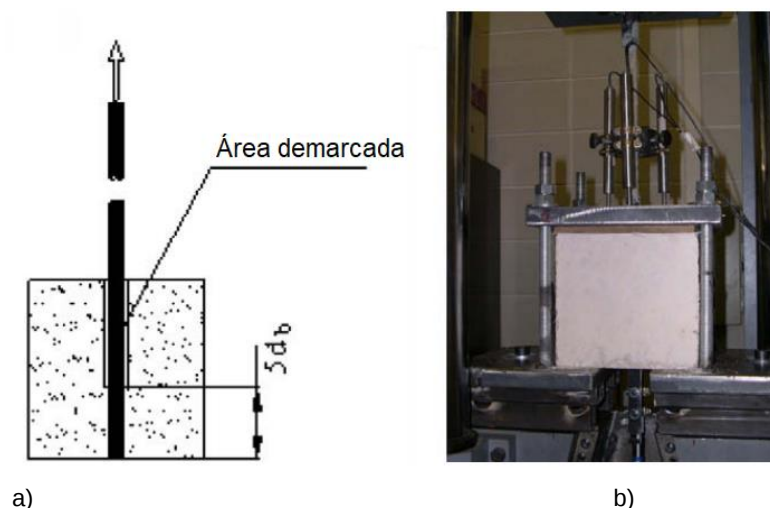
Configuração do teste *pull-out*, a) aplicação da barra, b) equipamento (Baena *et al.*, 2009).
